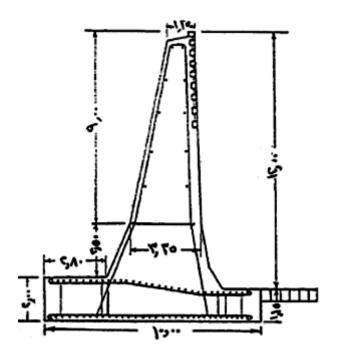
هويس بريجليو، إيطاليا، الحوائط فقط خرسانة مسلحة
